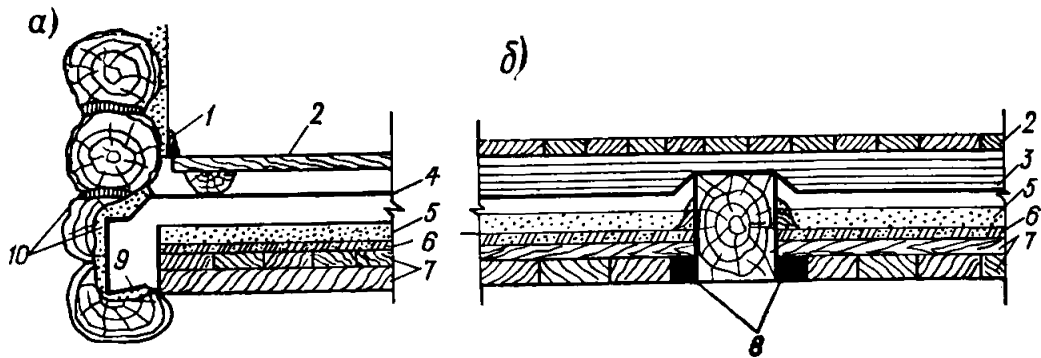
Детали междуэтажного перекрытия со щитовым накатом
